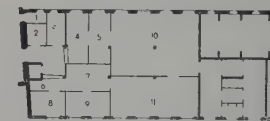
Krankenhaus Belzig — Wäscherei Grundriß 1:800
